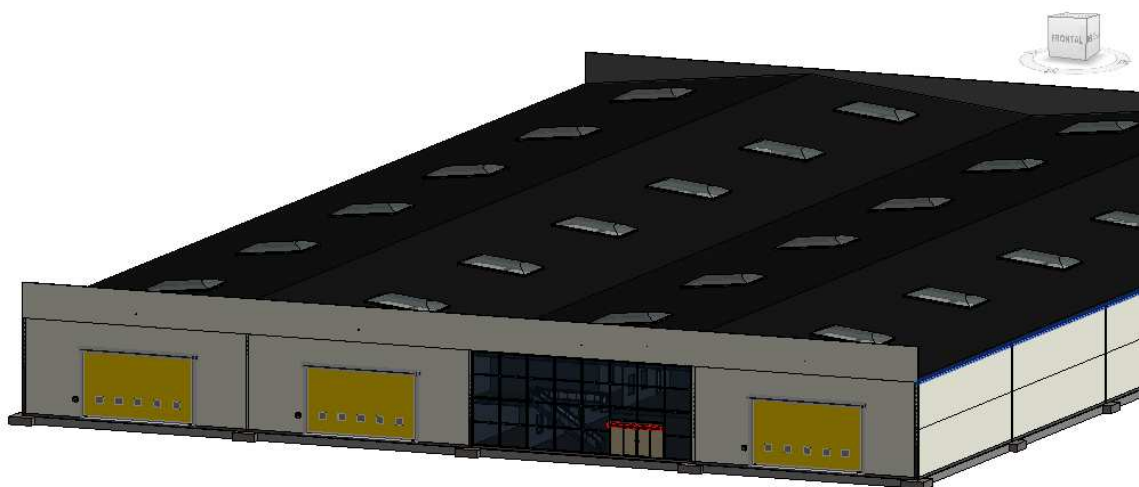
| MODELADO MURO CORTINA, VENTANAS Y PUERTAS “LOD 200” | Fuente propia
